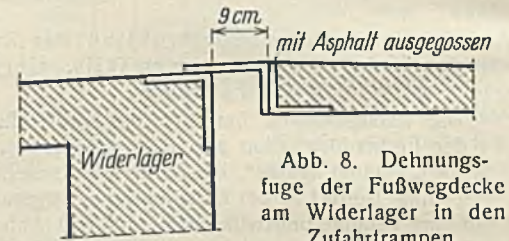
Dehnungsfuge der Fußwegdecke am Widerlager in den Zufahrtrampen.
